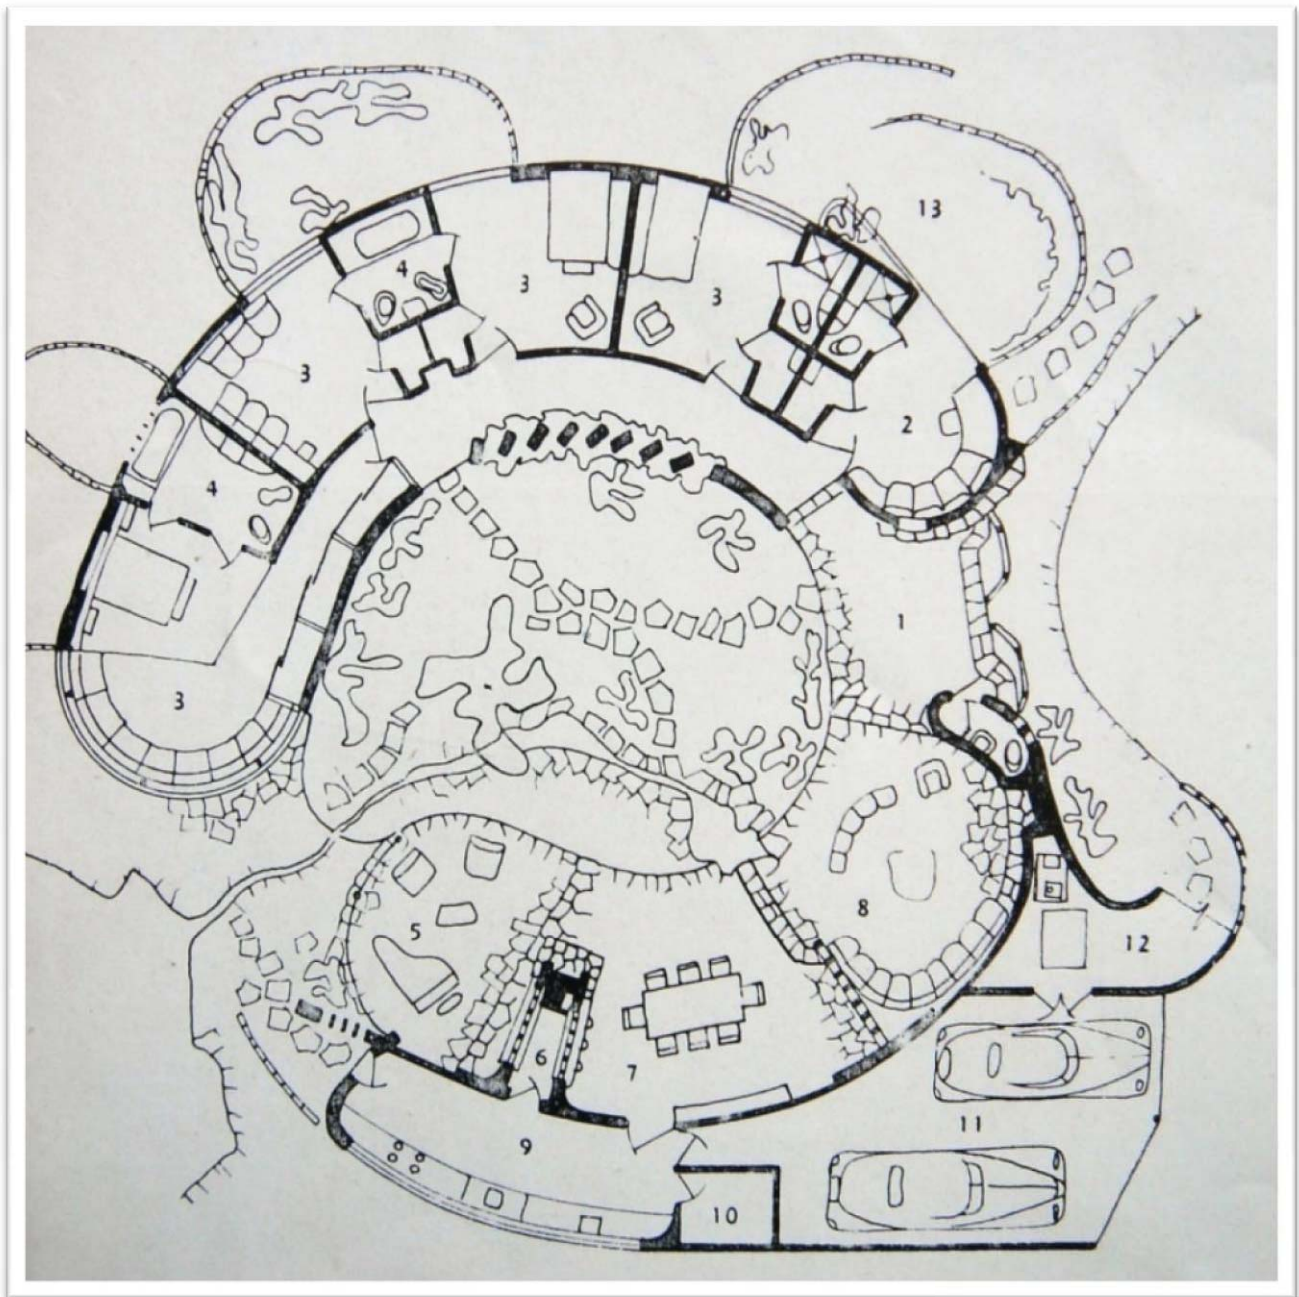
Casa en Sierra Leona. Arquitecto Lazo (Katzman 1963)
